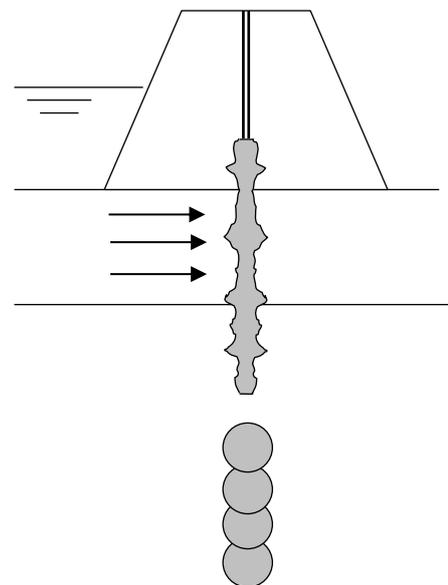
Croquis de barreras de impermeabilización de impermeabilización
